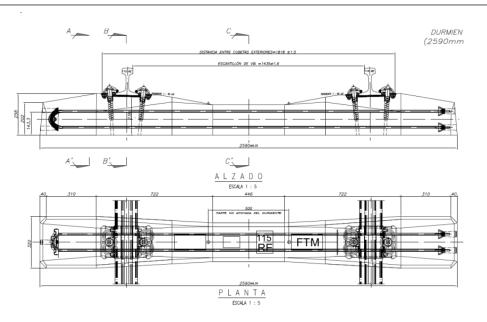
Detalle y geometría de durmientes de concreto monolítico postensados a utilizarse en vías del Tren Maya. Adaptado de: Jorge Cruz. (26, enero, 2023). Plataforma y vía. [Planta Detalle Durmiente con Suela Bajo Durmiente]. Tramo 2 Libramiento Ferroviario Campeche (TMPELFC-2-VA-VIA-PLA-1204 E00). Control y archivo documental del proyecto ejecutivo del Libramiento Ferroviario de Campeche del Tramo 2 del Tren Maya.
